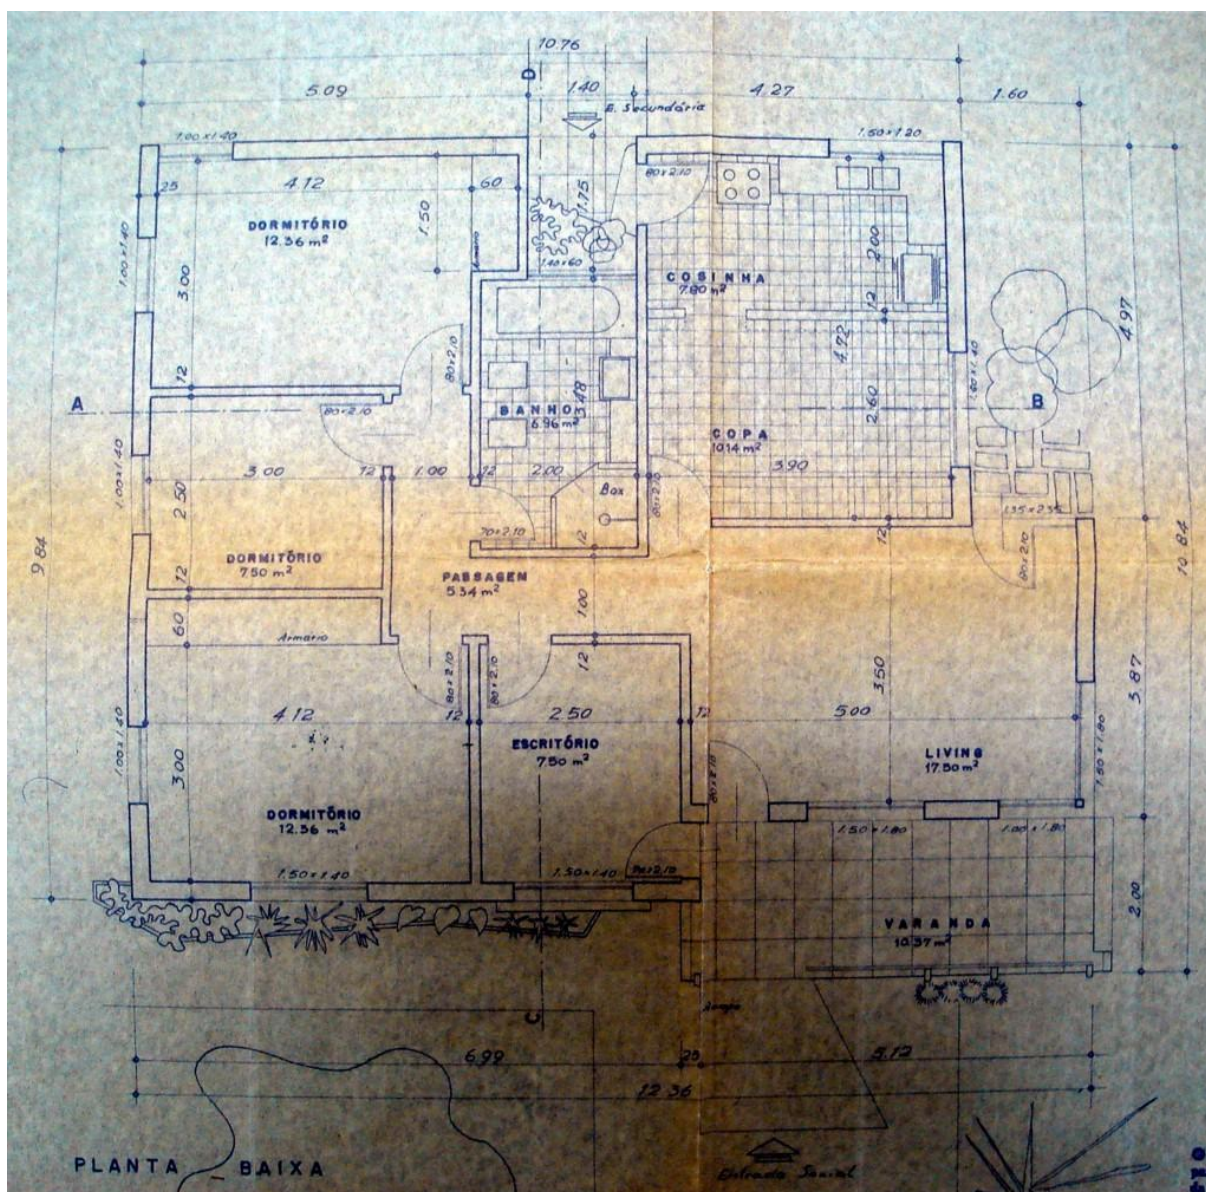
Projeto Arquitetônico / Planta baixa (Residência Rua Tomé de Souza, nº 27)
